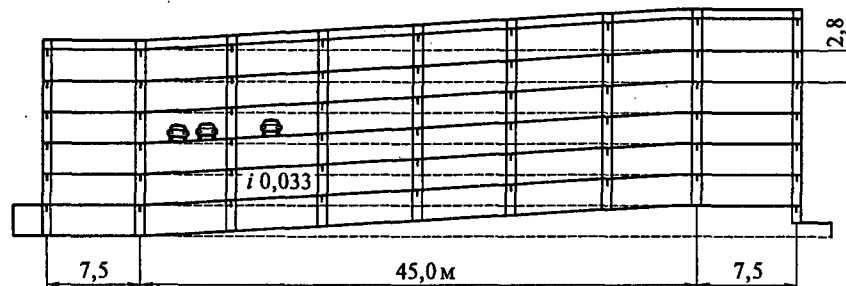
Схема автостоянки с наклонными перекрытиями
